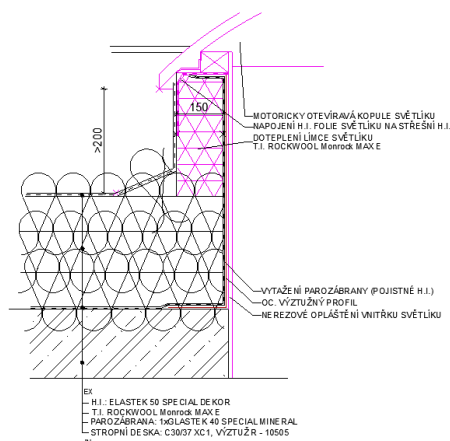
Detaily opláštění, zdroj: projektová dokumentace
